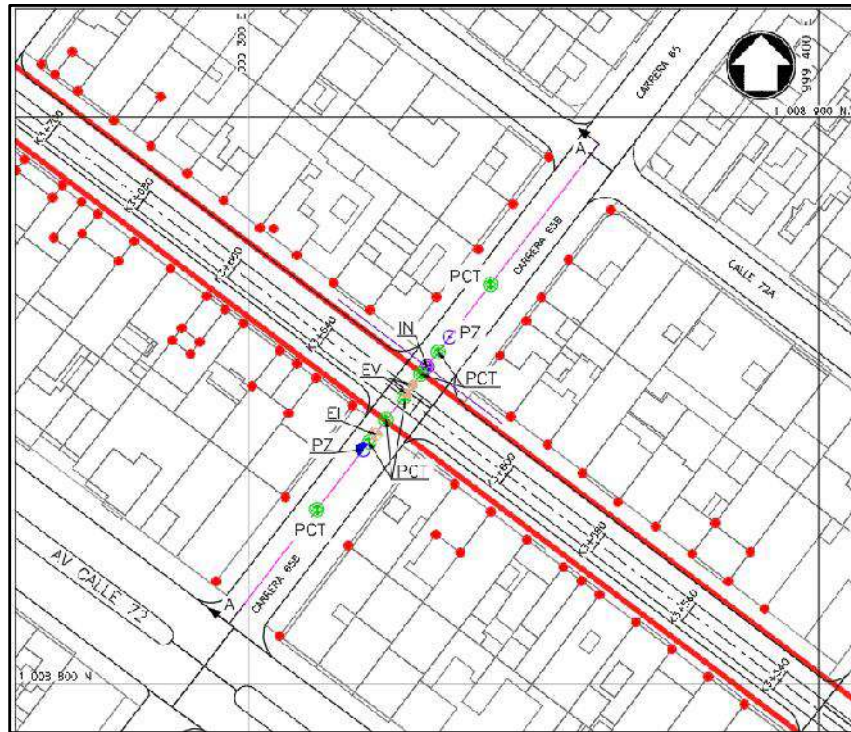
Planta tipo de instrumentación requerida para el túnel.
